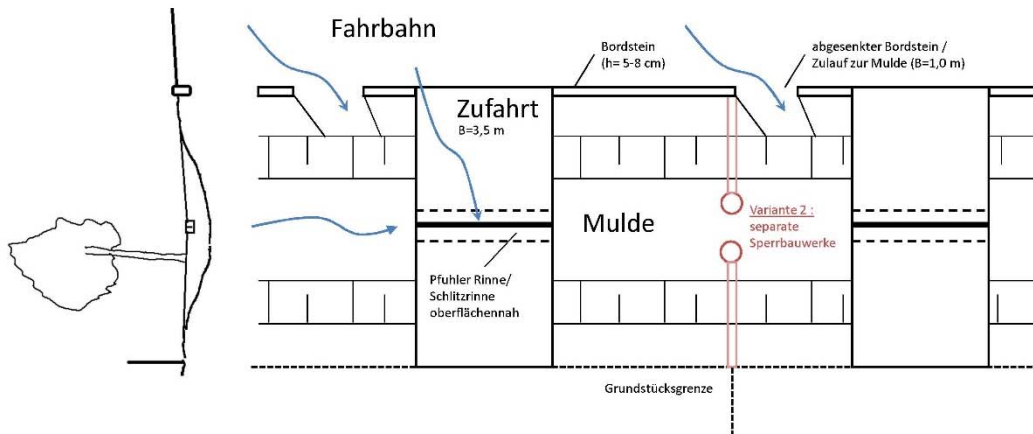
Grundriss mit Querschnitt Wohngebietsstraße
